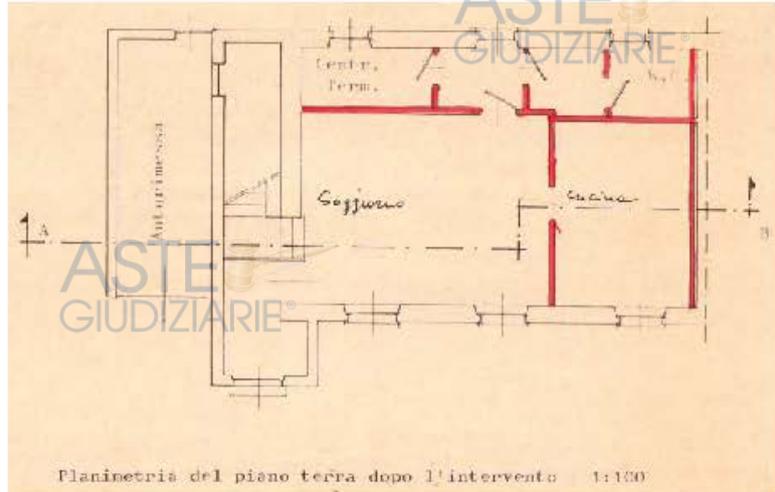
Estratto situazione autorizzata con Autorizzazione 79 del 23/01/1992 – pianta piano terra
